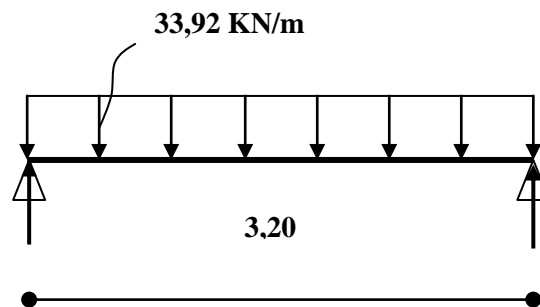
Schéma statique de la poutre palière (ELU)
